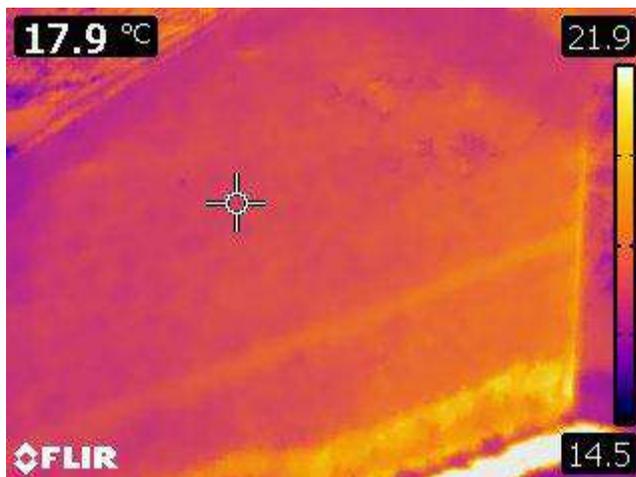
FLIR0274. Immagine termocamera del 24.04.2018. Tessitura muraria della Sala Teatro. Prospetto Sud
